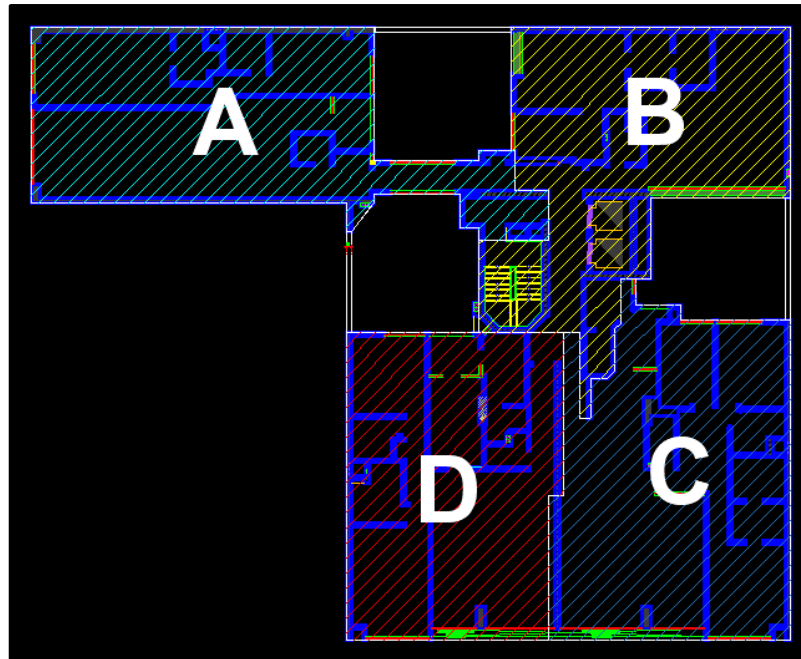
Sectorización de planta típica. (Piso 3, 4, 5 y 6) Fuente: Propia
